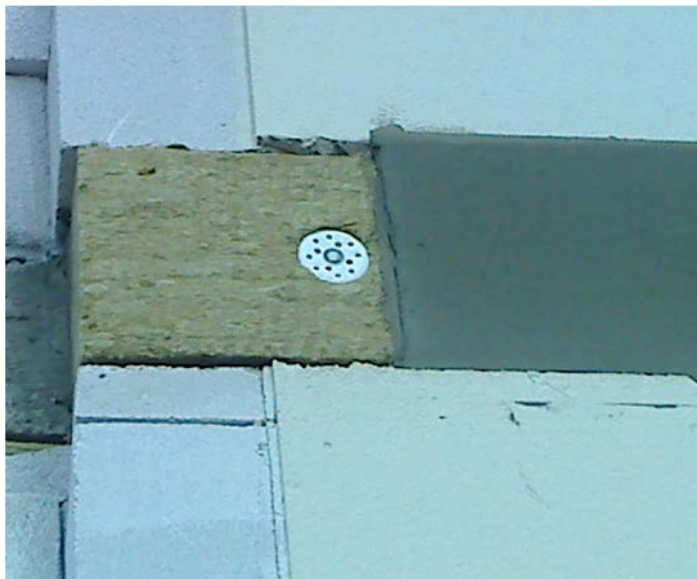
Пример тепловой изоляции торца межэтажного перекрытия
